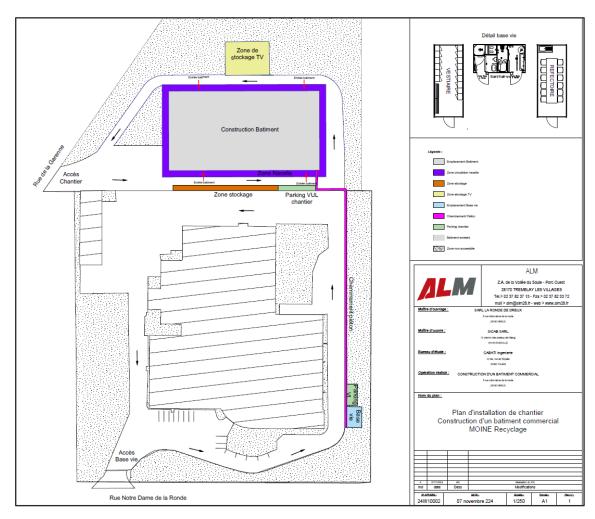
Plan d'installation du chantier du futur bâtiment (source : GTP)
